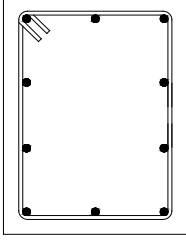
Denah Tinjauan Kolom Lantai 3
